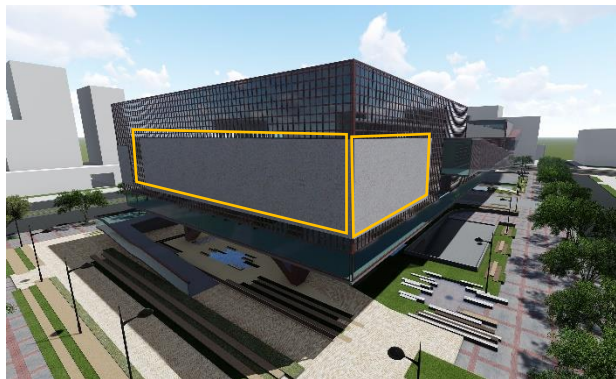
desarrollo en fachada de elementos - Elaboración propia 2021
